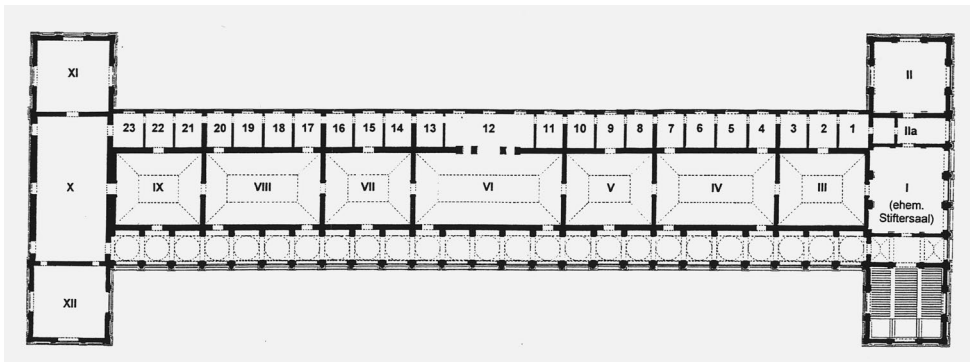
Grundriss des Obergeschosses der Alten
